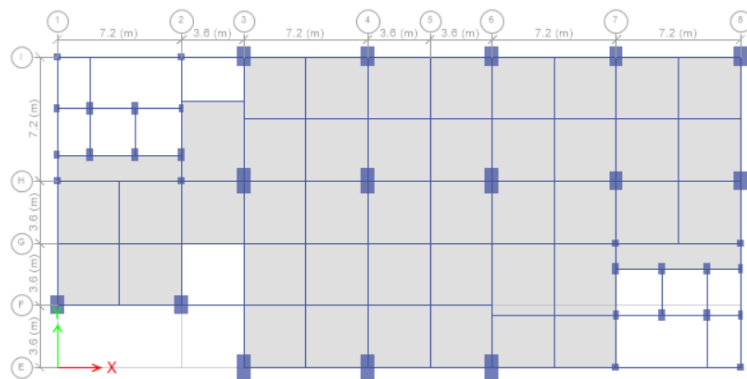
di bawah ini. Pada lantai 4 – 13, area tersebut di fungsikan untuk ruang kelas, ruang dosen, dan *hall*.
